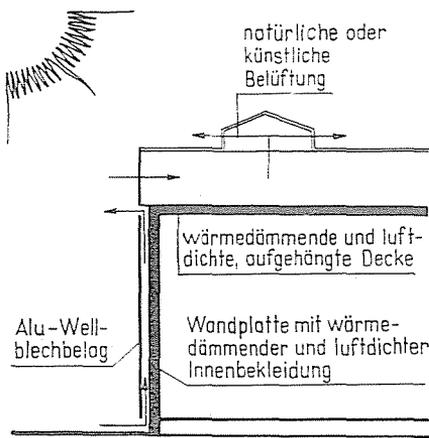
Wand- und Deckenkonstruktion mit belüfteter Luftschicht
